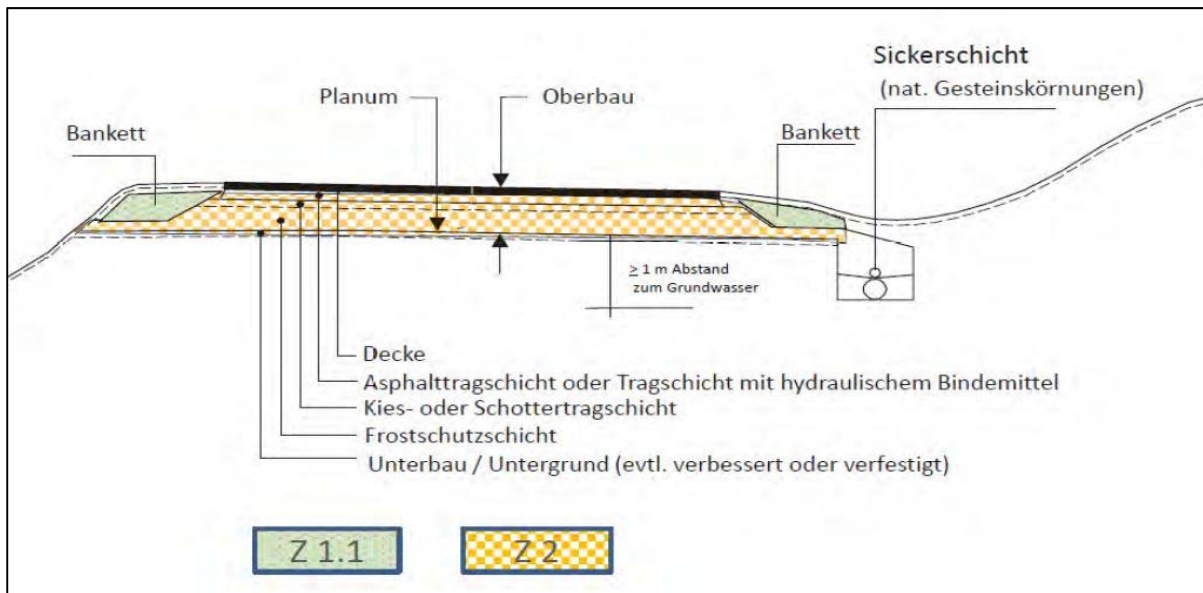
Beispiel für Einsatzmöglichkeiten der Einbauklasse 1 und 2 im Oberbau des Straßenbaus⁷⁵
